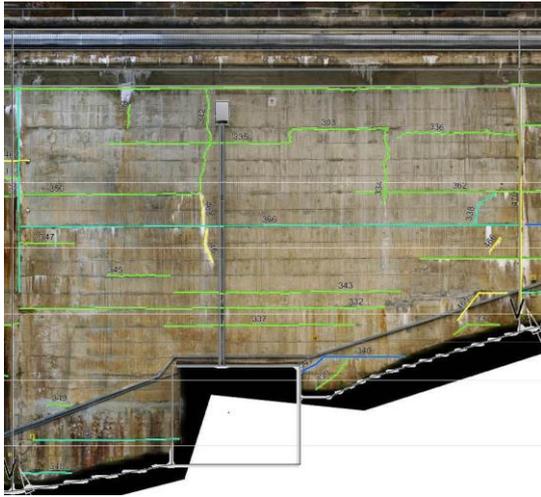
Relevé d'un état de fissuration sur ortho-photographie
